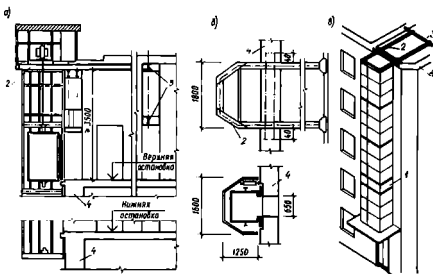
Конструкция наружного подвешного лифта:
